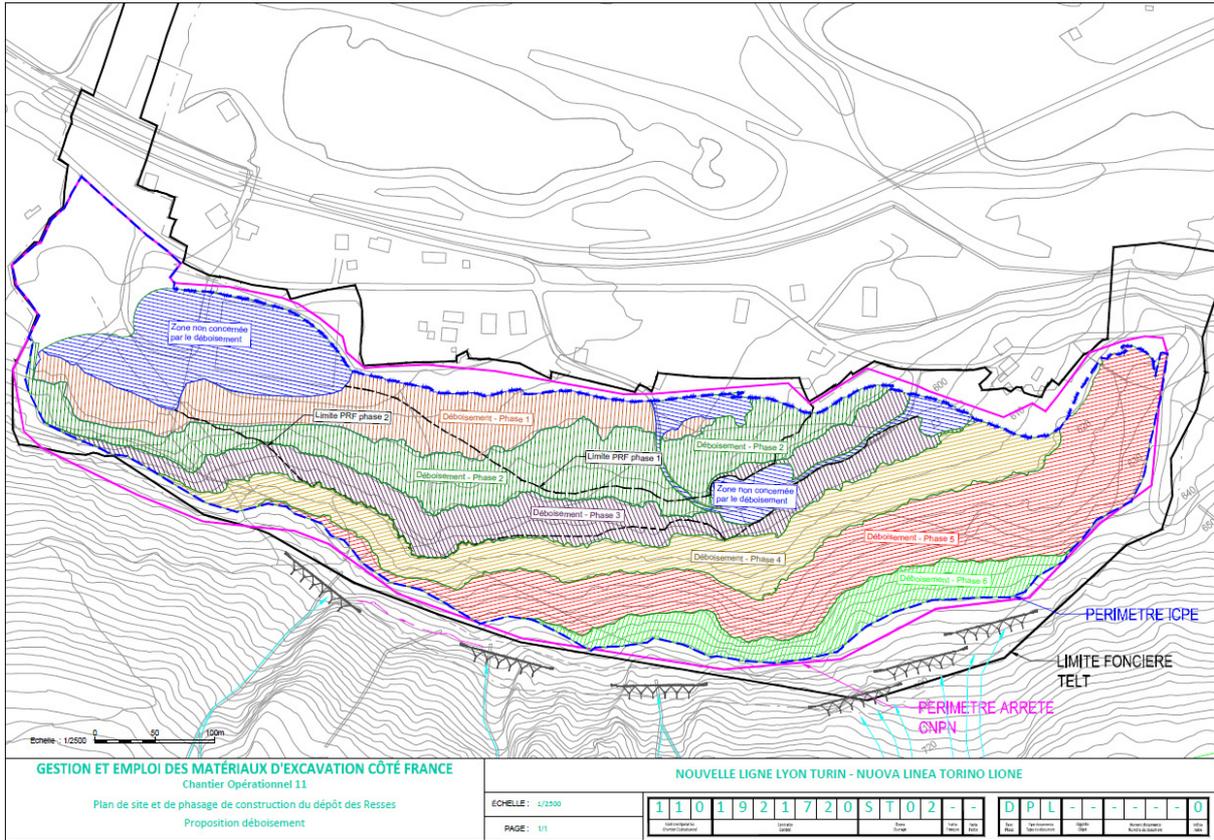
Phasage de la construction du dépôt – Déboisement (ALTI, avril 2021)
